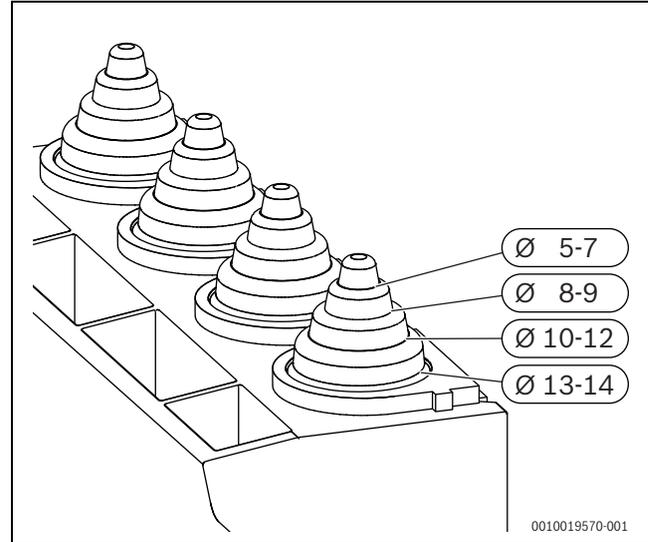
Zugentlastung an Kabeldurchmesser anpassen
